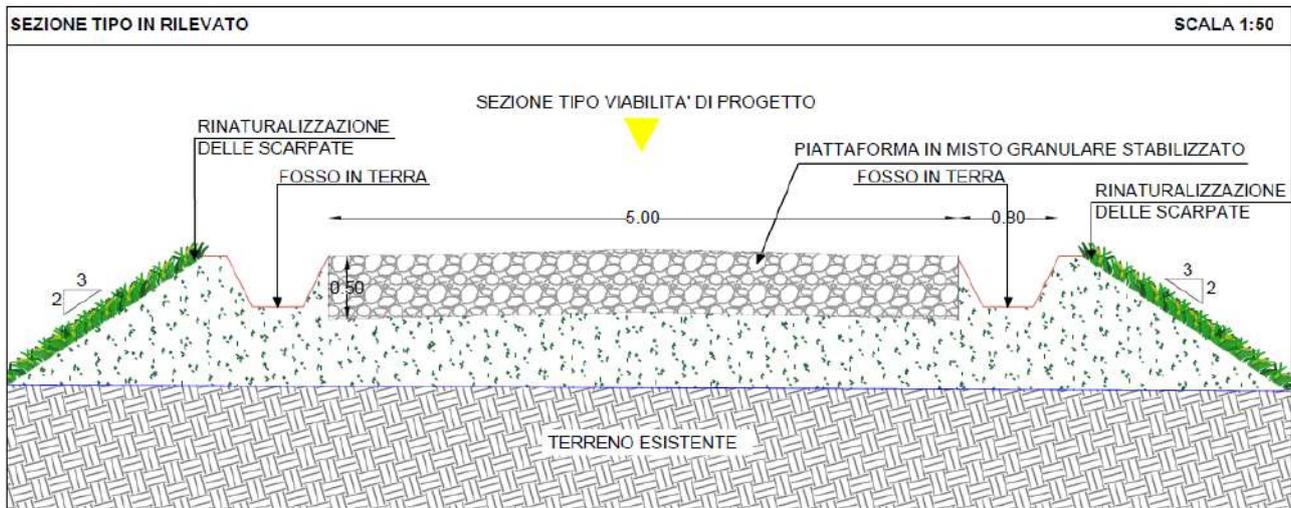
Sezione tipo in rilevato per la nuova viabilità
